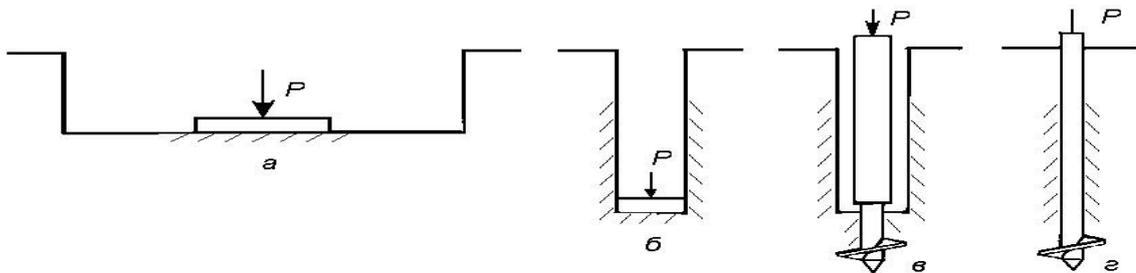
Испытания грунтов плоским и винтовым штампами [15].
